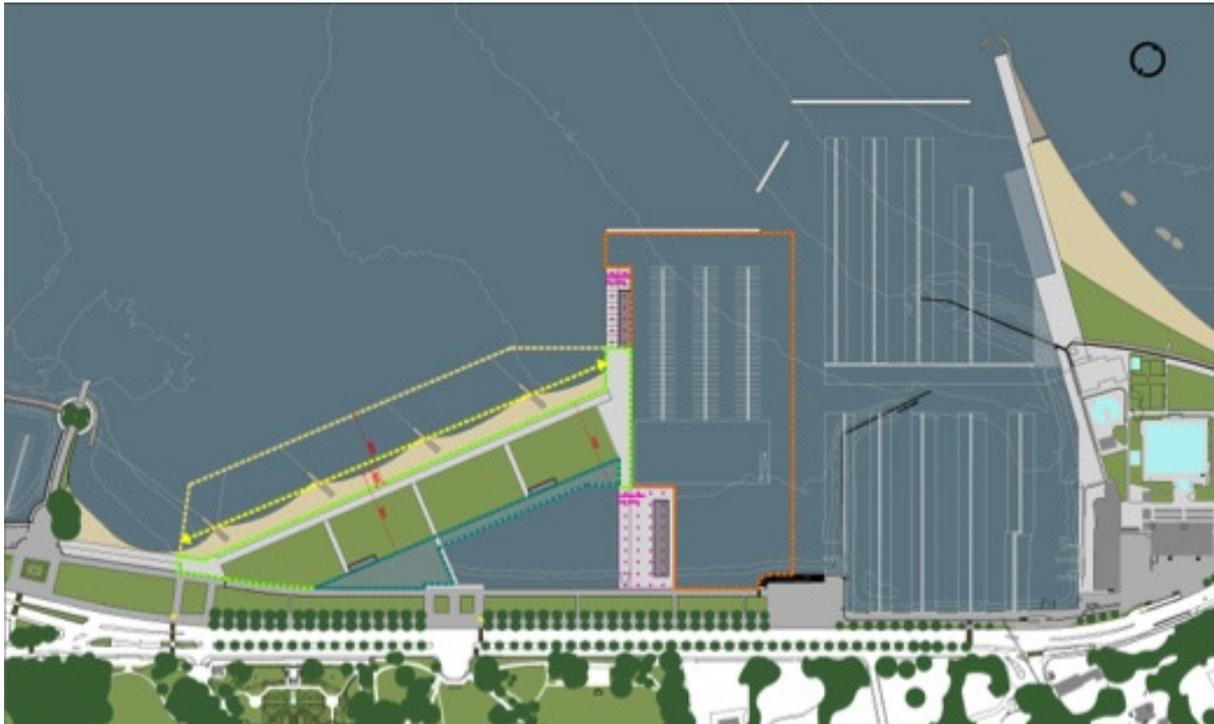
Variante V1-A, « plan d'eau arrière » (également intitulé « plan d'eau intérieur »)
